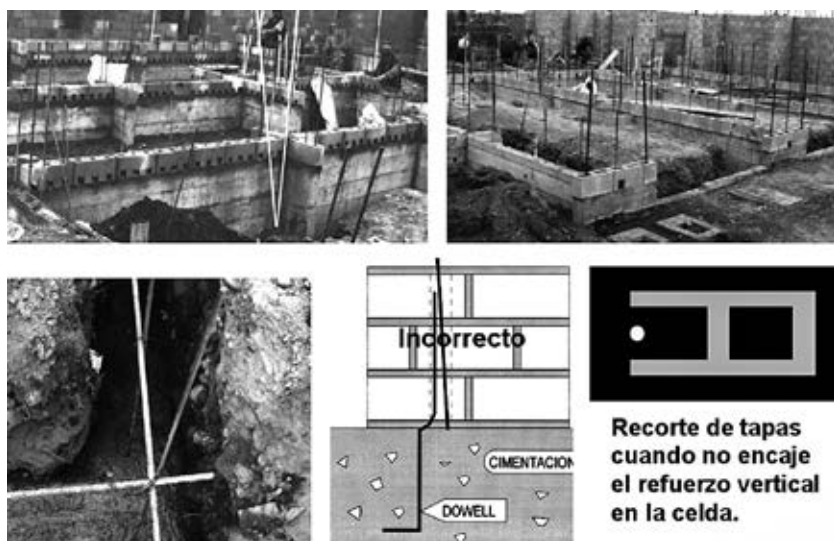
Cimentación y refuerzo vertical en los muros de Albañilería Armada.
